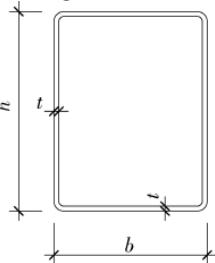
矩形钢管混凝土柱截面尺寸示意
